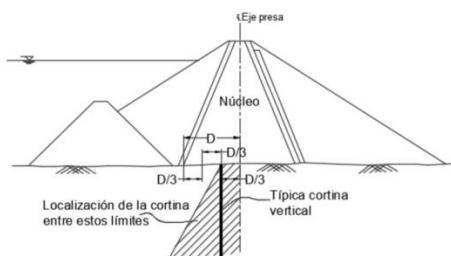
Ubicación típica de una cortina profunda en una presa con núcleo de arcilla. Adaptado de "Construction and design of cement grouting" de Hously, A.C. (1990).
